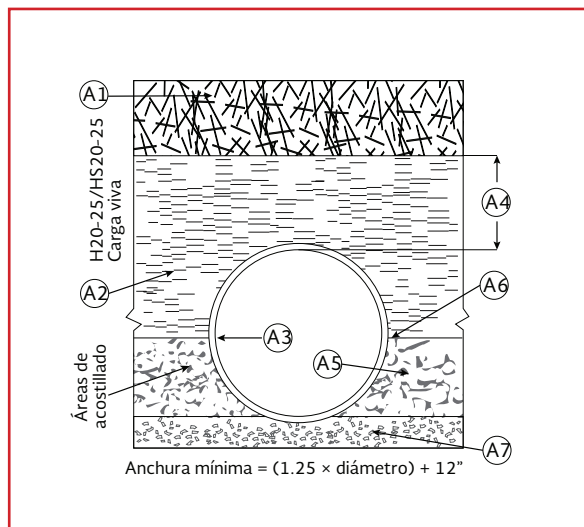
Instalación colchón bajo (<610 mm de arriba del pavimento a la parte superior del tubo)
